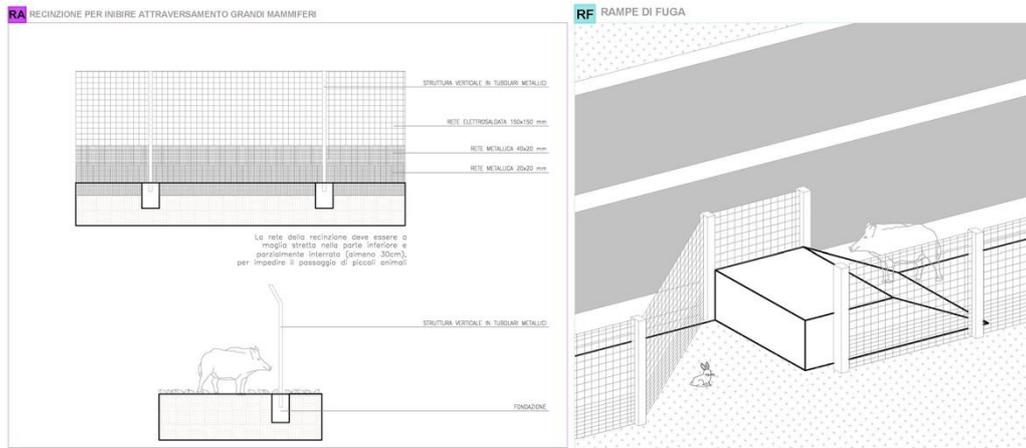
Assonometria schematica, prospetto e sezione della recinzione e delle rampe di fuga
